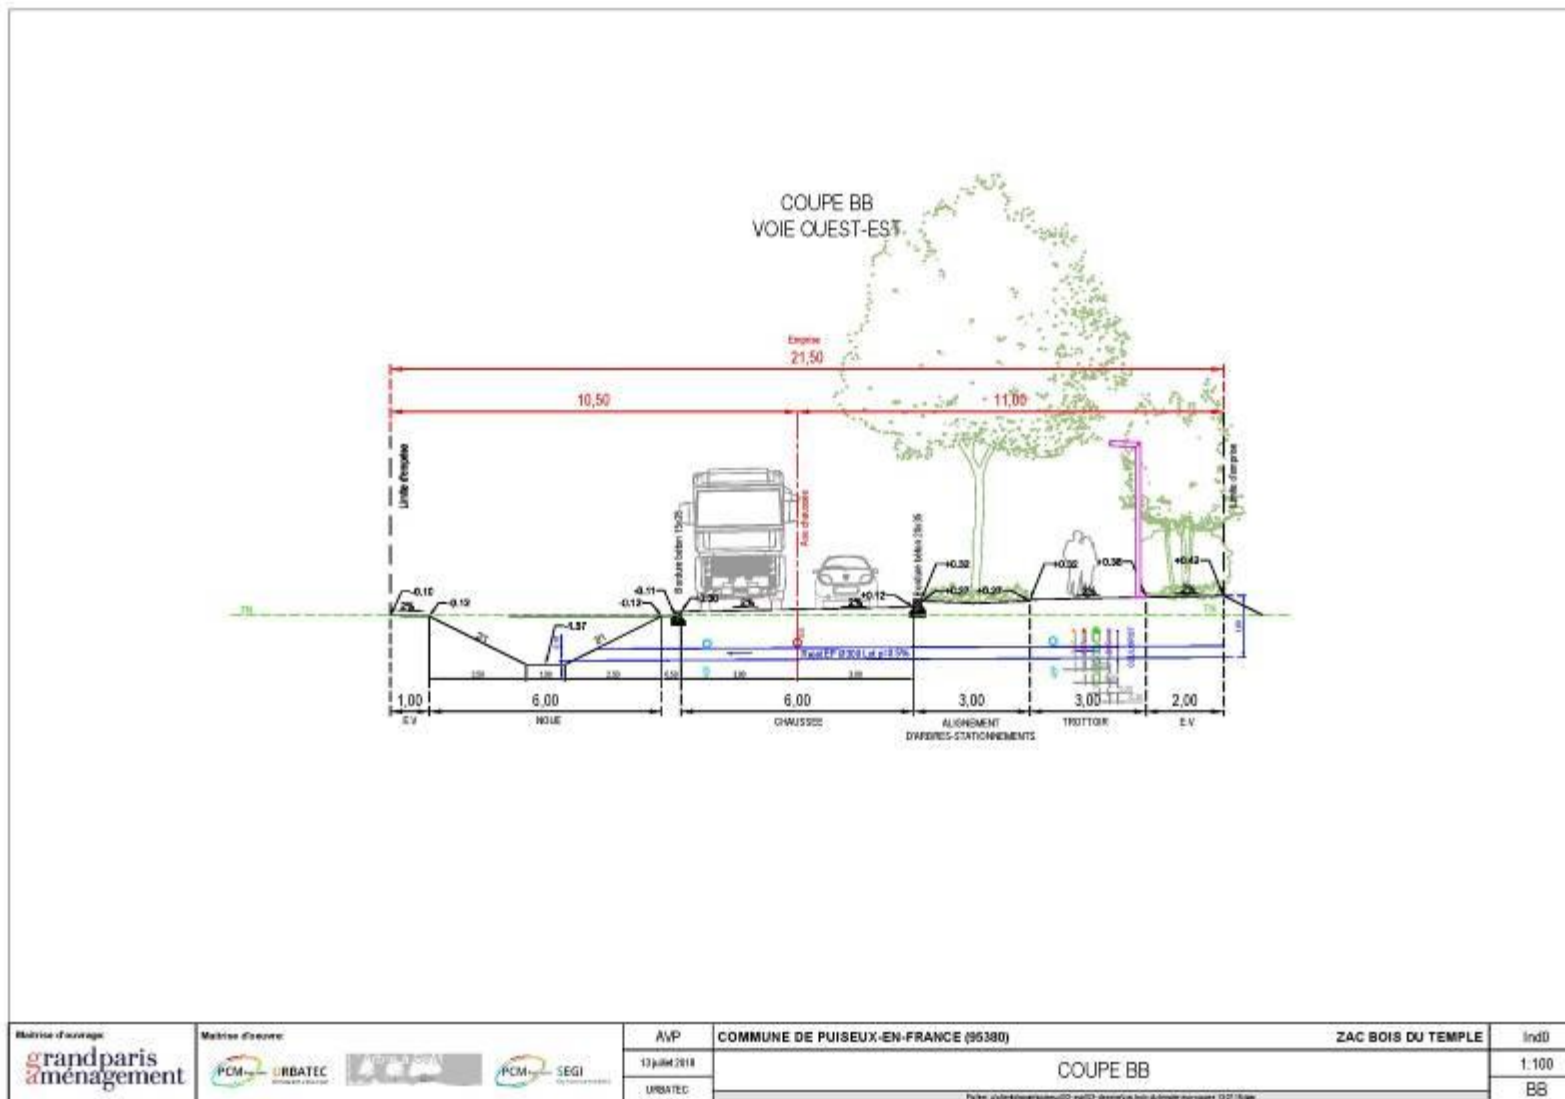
Coupe de principe sur voirie Ouest-Est.
